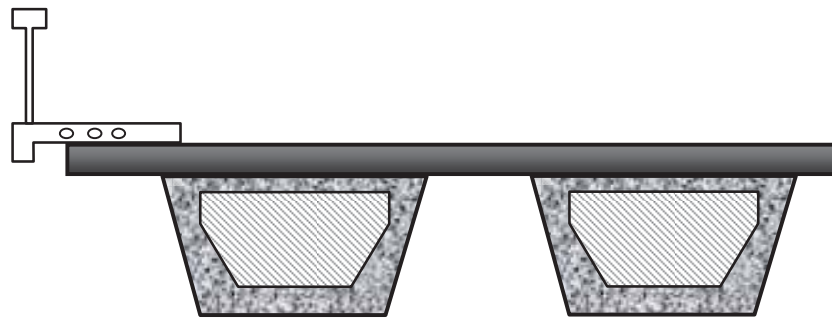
Esquema de la sección transversal tipo, en losas sobre vigas de sección en cajón
